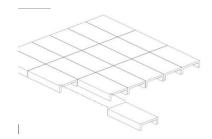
Unión de piso para vivienda de emergencia New temporany house Japón.
